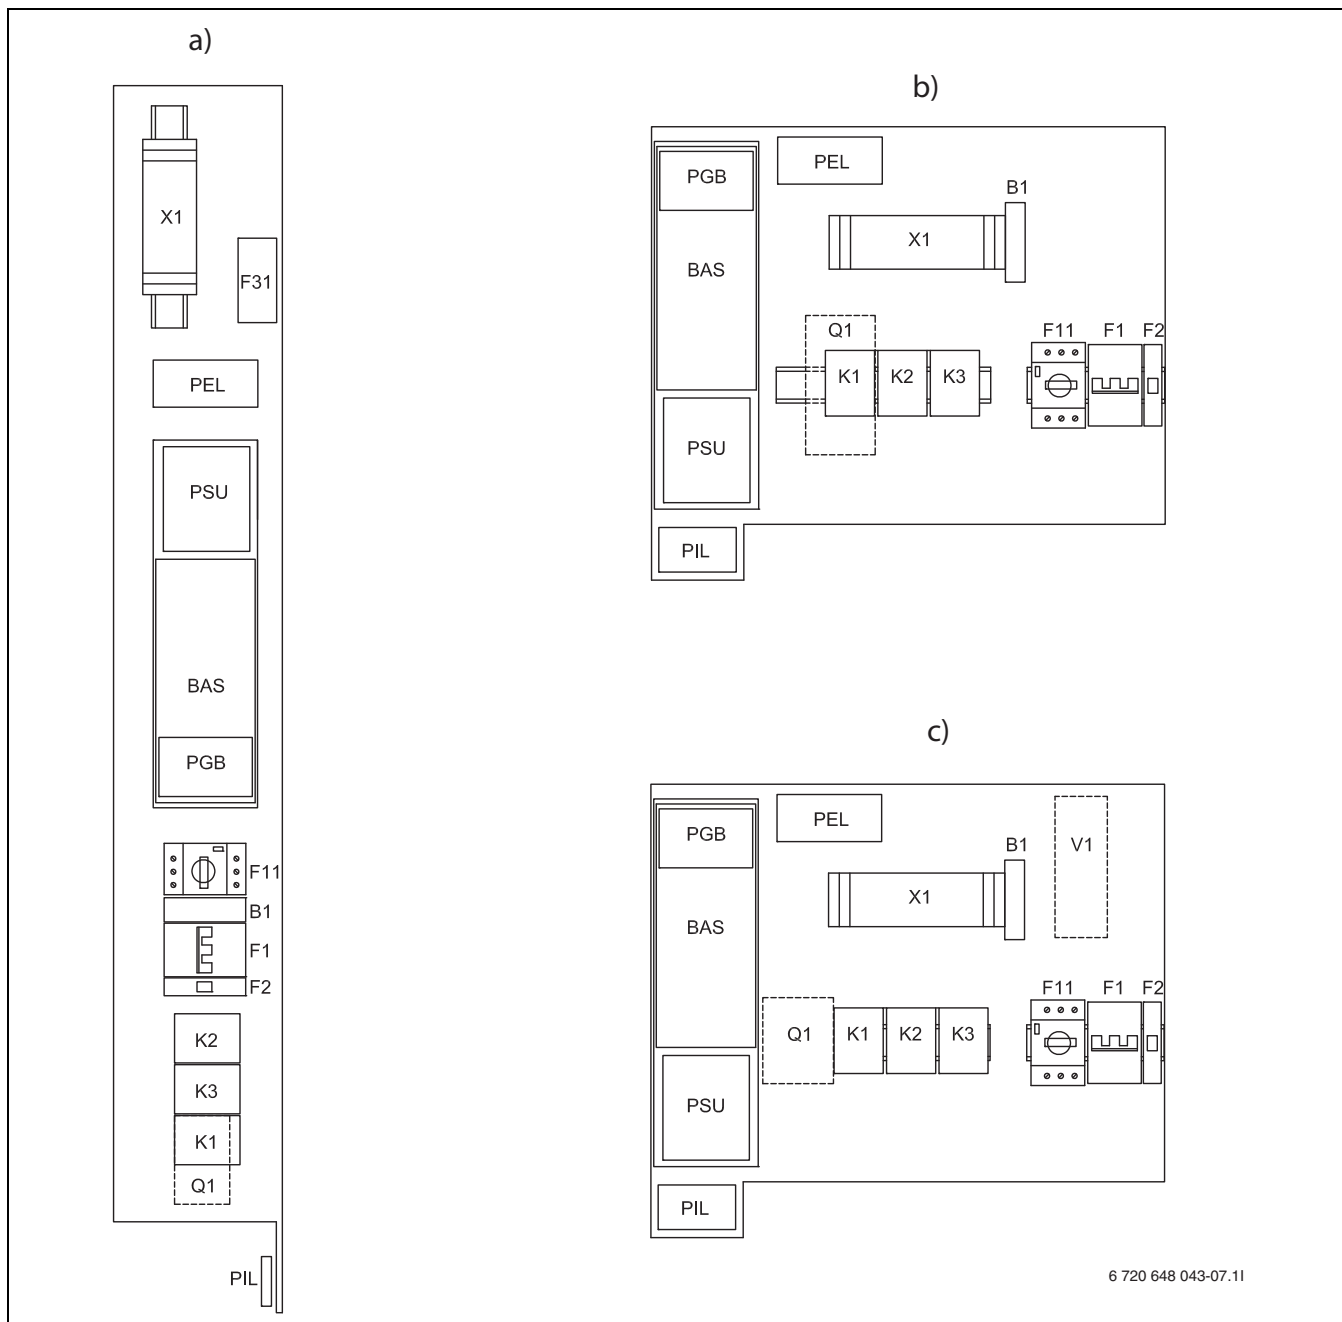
Přehled zapojení rozvodné skříně – tepelné čerpadlo
